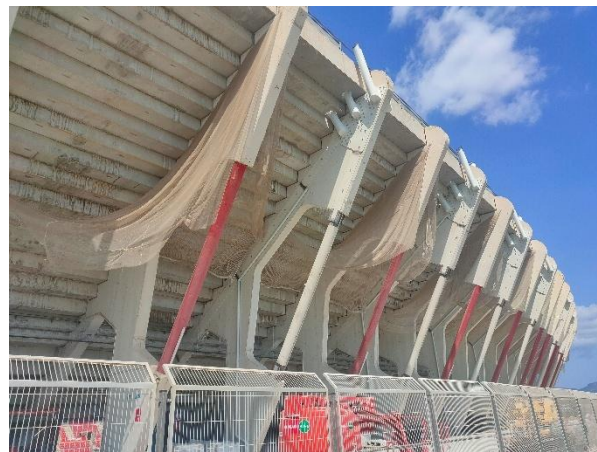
Foto durante el montaje de los armazones metálicos sobre los pórticos a reforzar.
